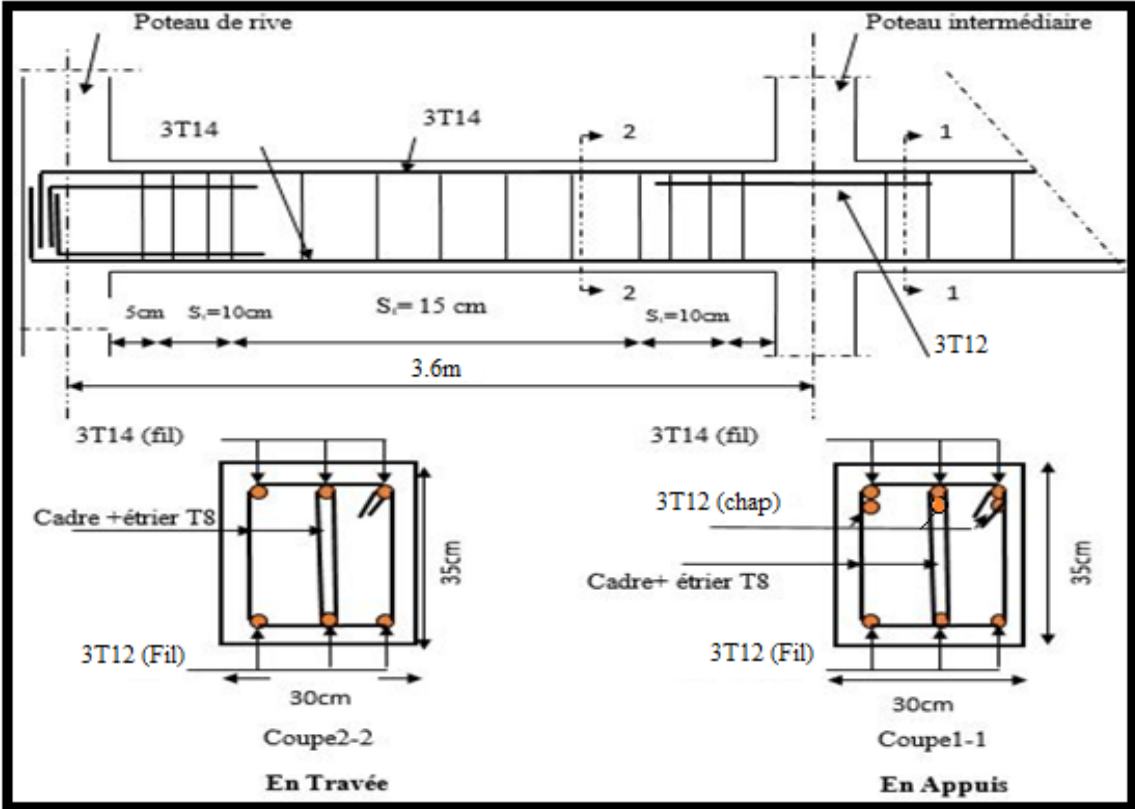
schéma de ferrailage des poutres secondaires associées au voile.
